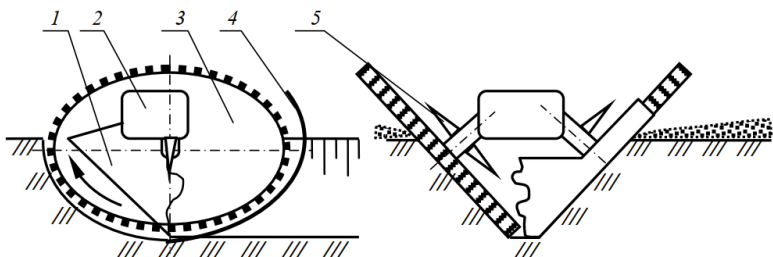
Схема рабочего органа двухфрезерного экскаватора-каналокопателя: 1 – двухотвальный клин; 2 – редуктор привода; 3 – дисковая фреза; 4 – отвал; 5 – рыхлители
